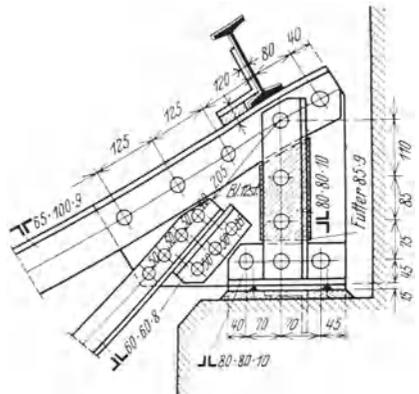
Auflagerpunkt eines Pultdachbinders.
